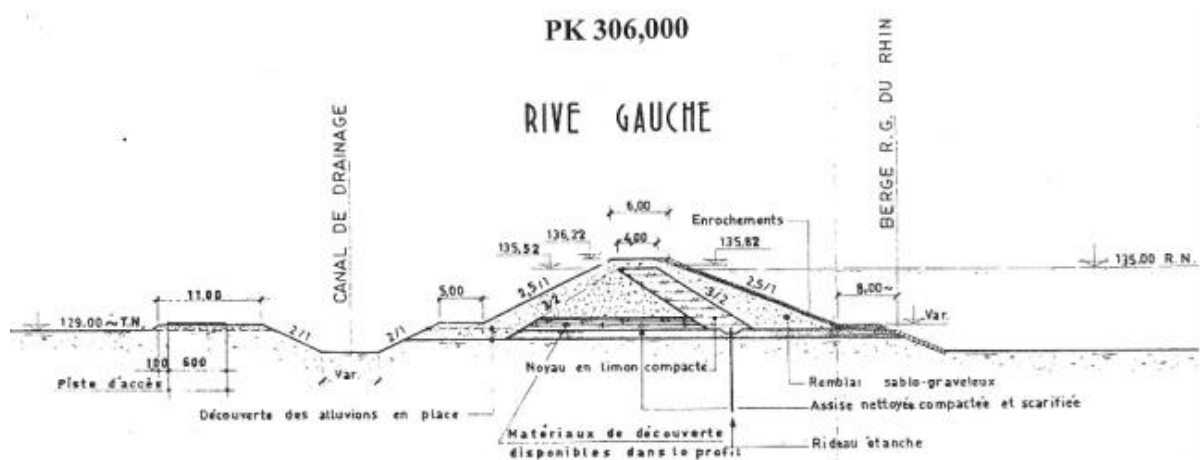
Coupe transversale du barrage latéral rive gauche au PK 306
